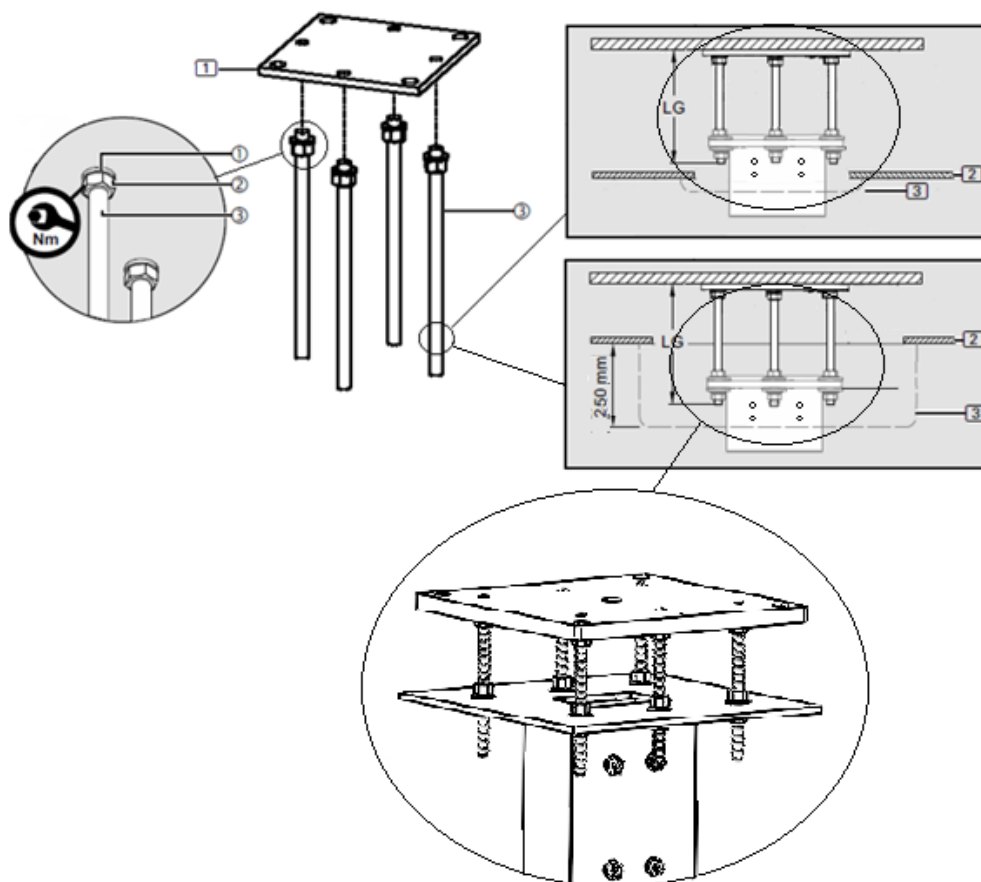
Installation de la plaque d'interface dans une pièce avec faux plafond
